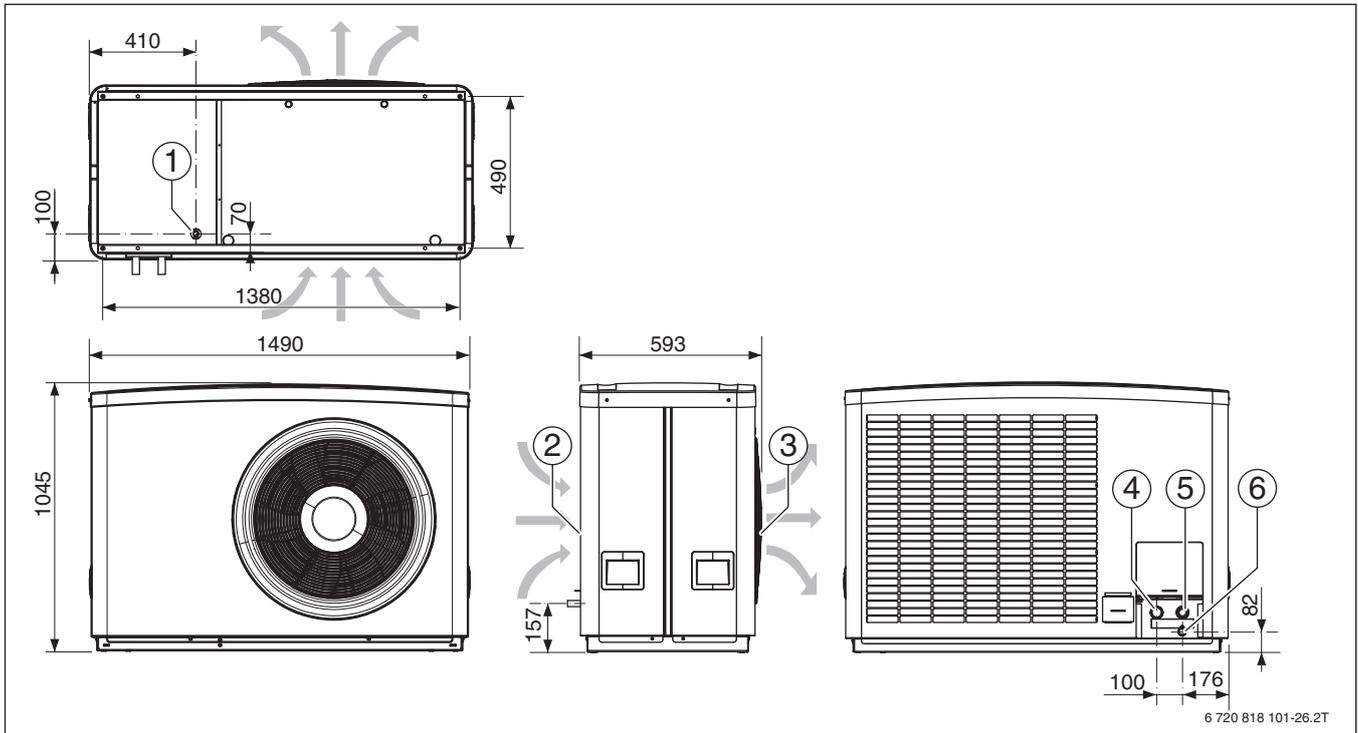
Abmessungen und Anschlüsse ODU W15 HT
